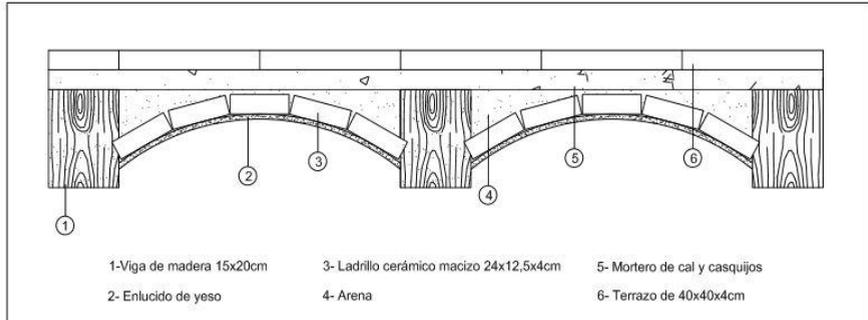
Detalle forjado planta primera. 2014. Propia.
